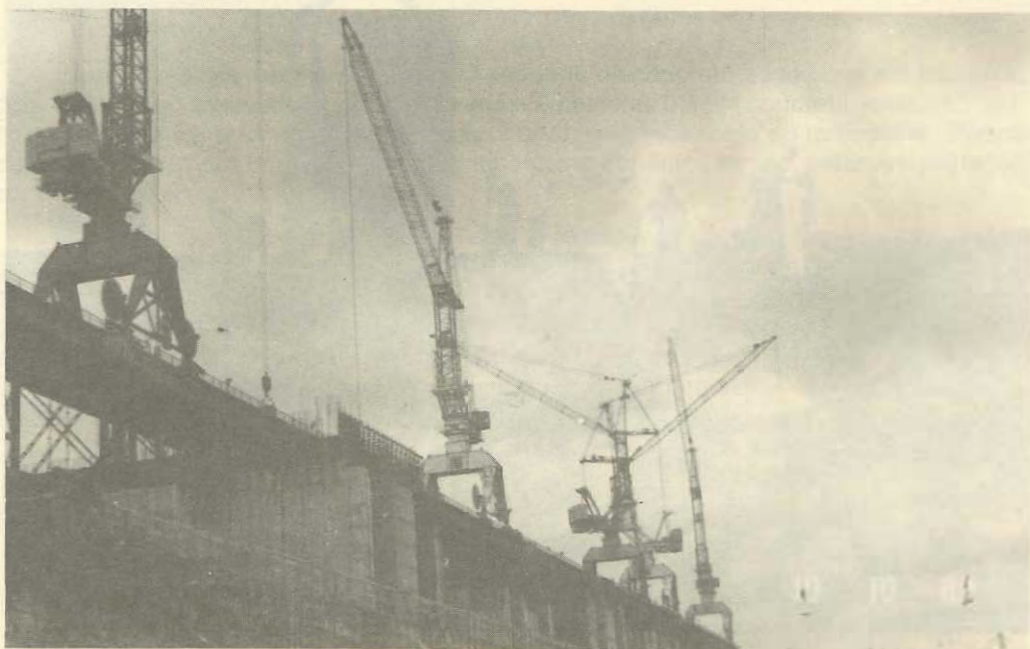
Guindaste tipo lança em "JIB", sobre torre, utilizado para a colocação do concreto - Tucuruí
